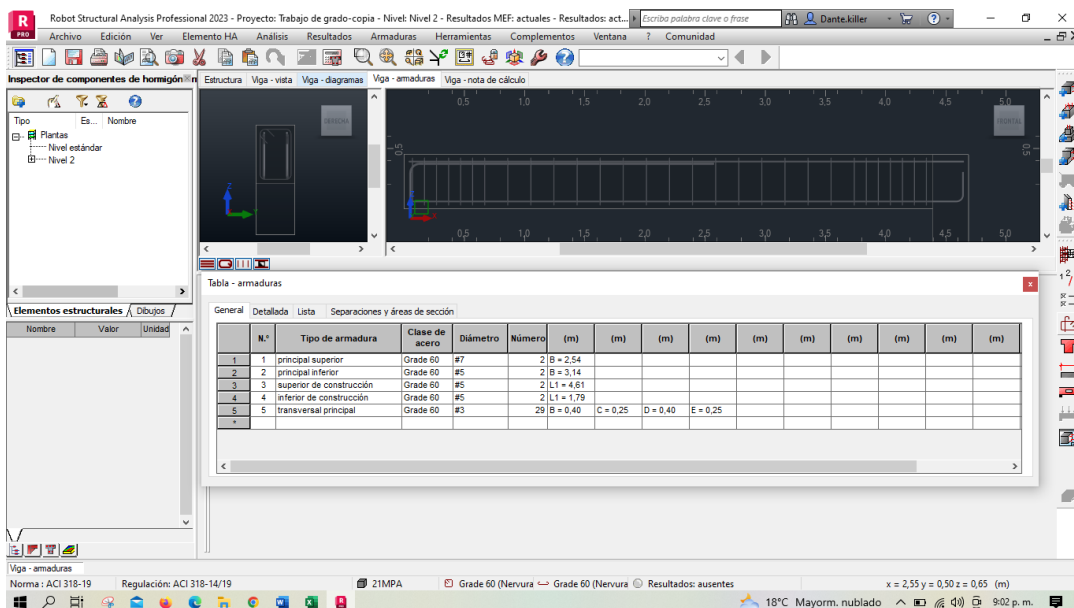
Parámetros para la disposición de armaduras acero transversal.
